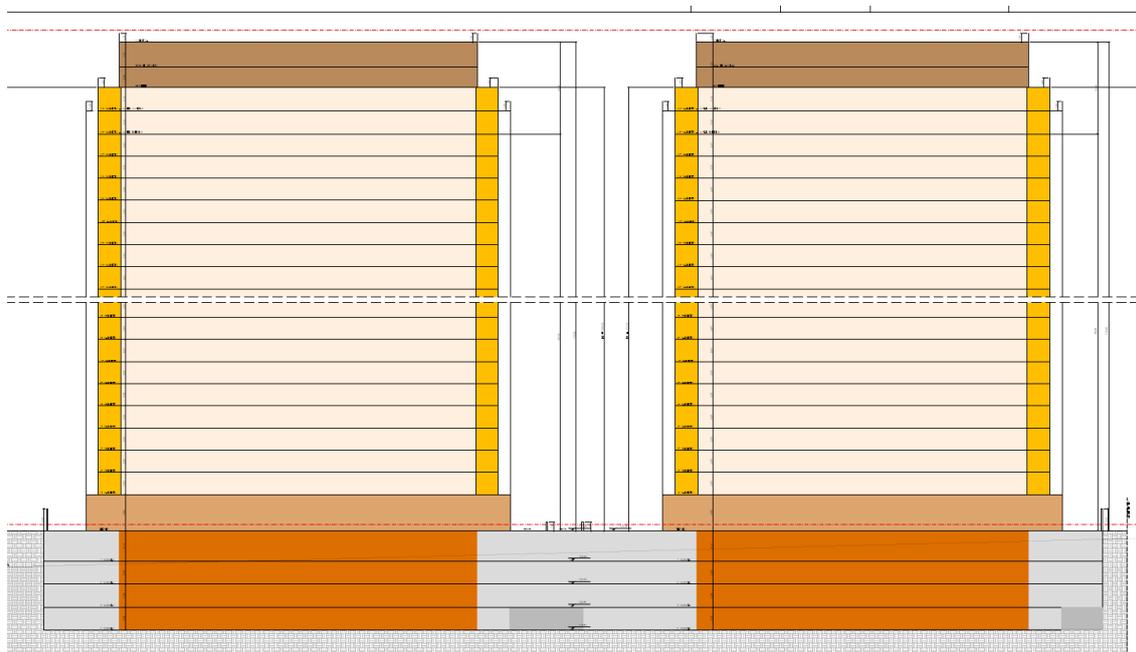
Corte esquemático AA torres 1 e 2 do setor B1.
